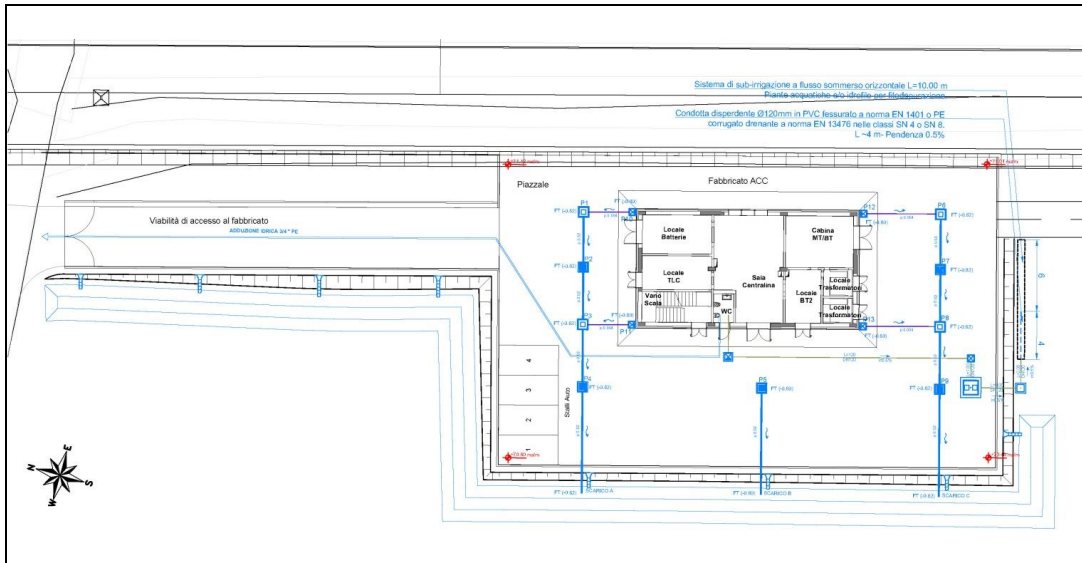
Schema di drenaggio del piazzale e della viabilità di accesso
